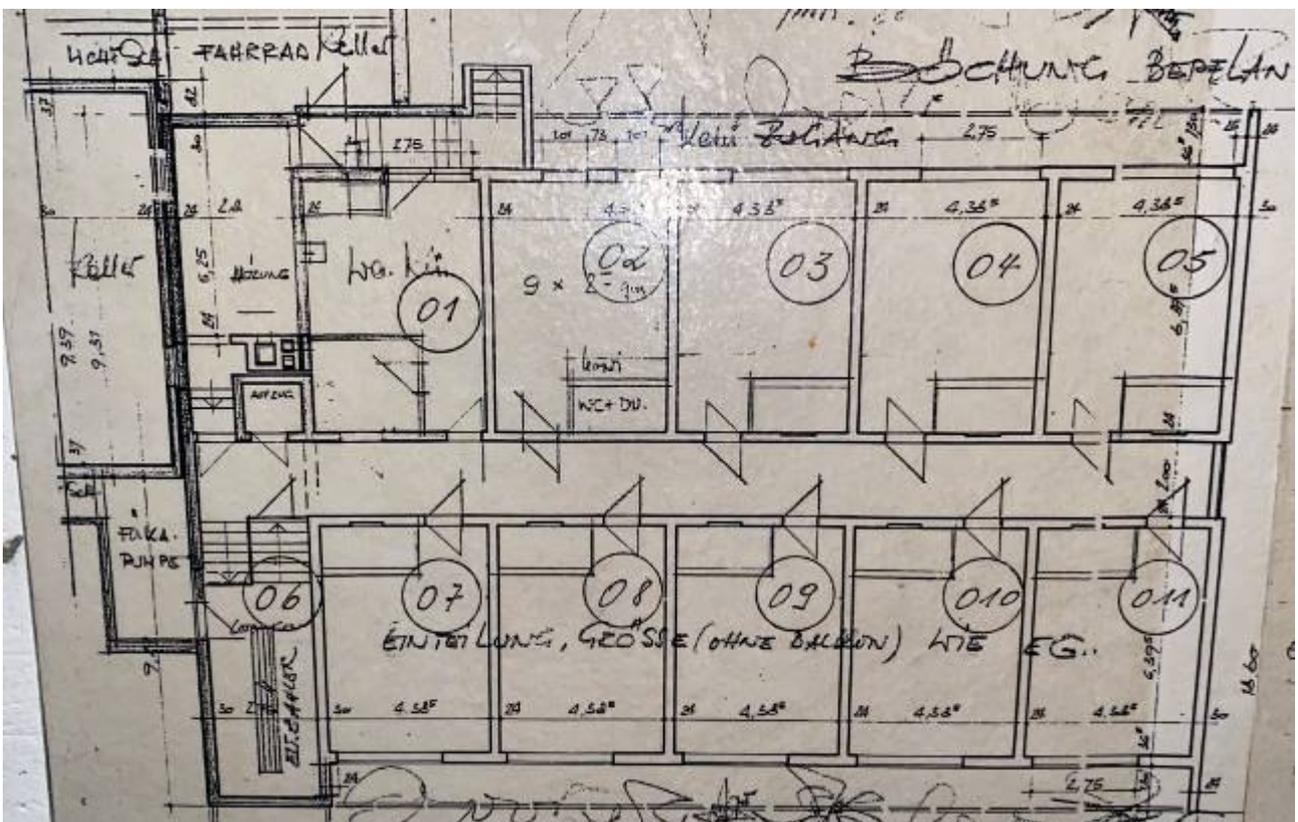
Foto des SV; Grundriss Kellergeschoss; Quelle: Montageplan
